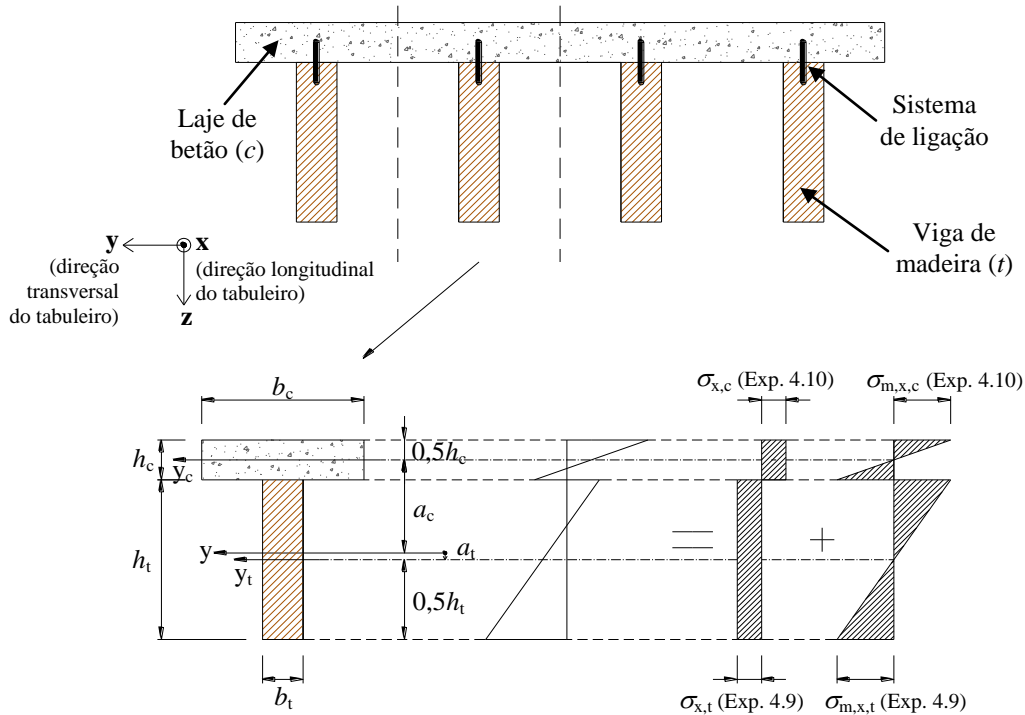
Parâmetros utilizados na determinação das tensões na secção transversal de uma viga mista madeira-betão.
